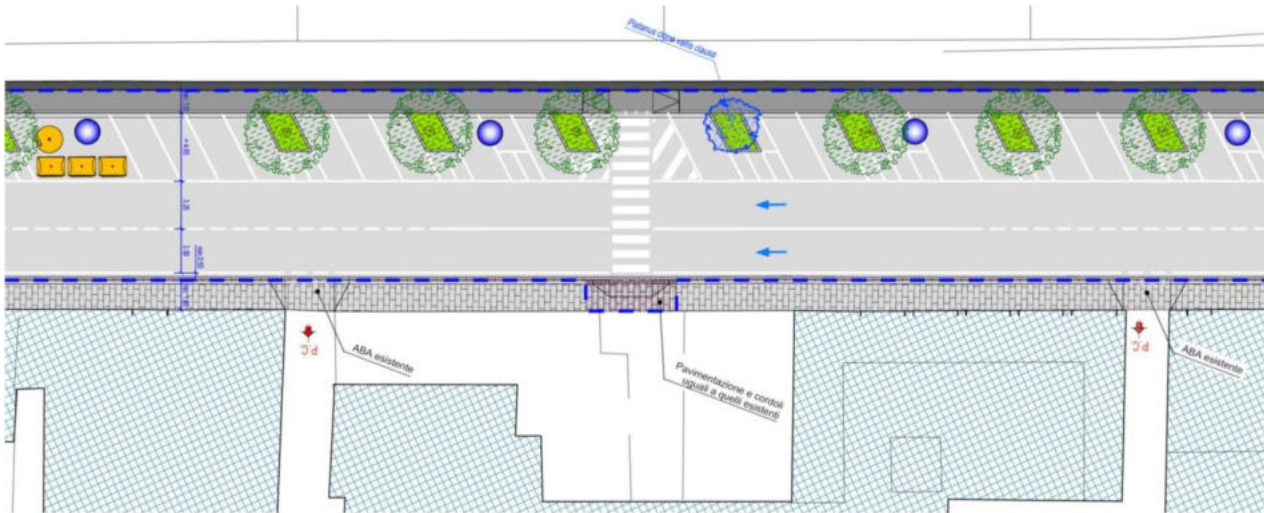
Progetto Definitivo Approvato - Stralcio planimetrico di viale G. Milton
